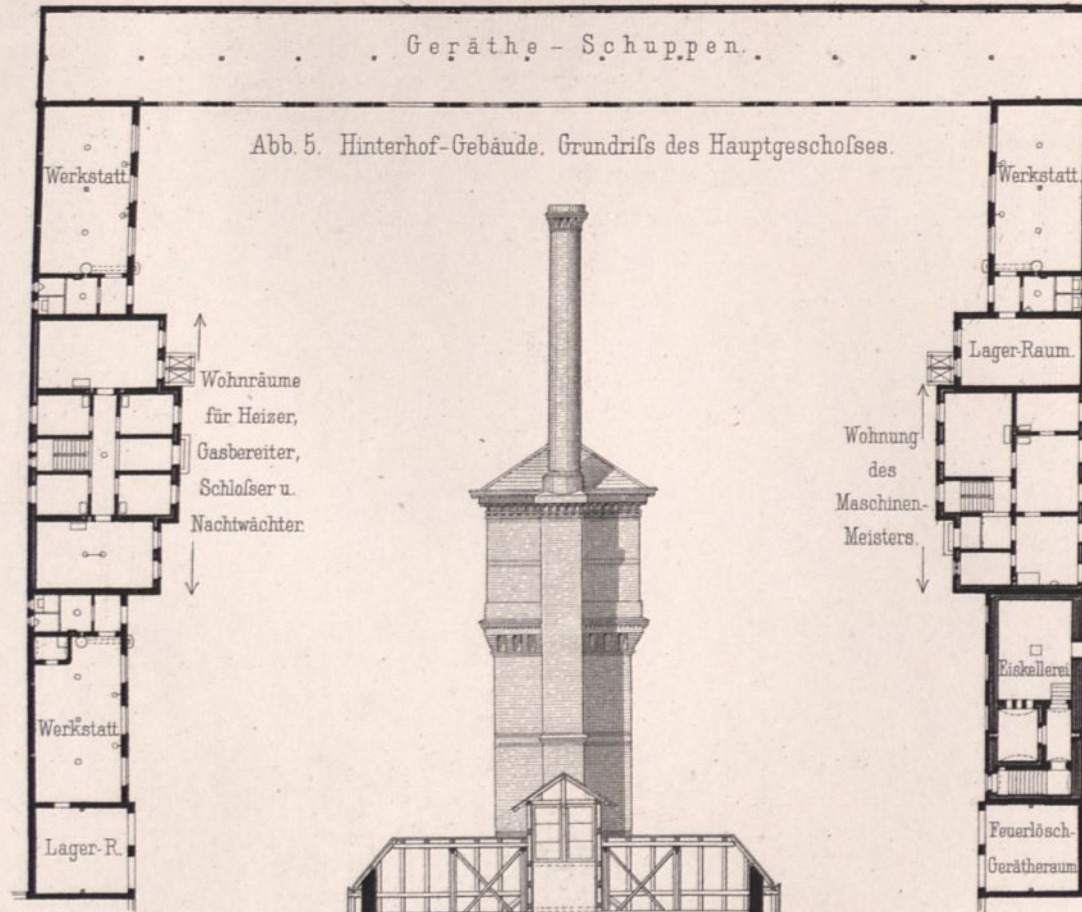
Hinterhof-Gebäude. Grundriss des Hauptgeschosses.
